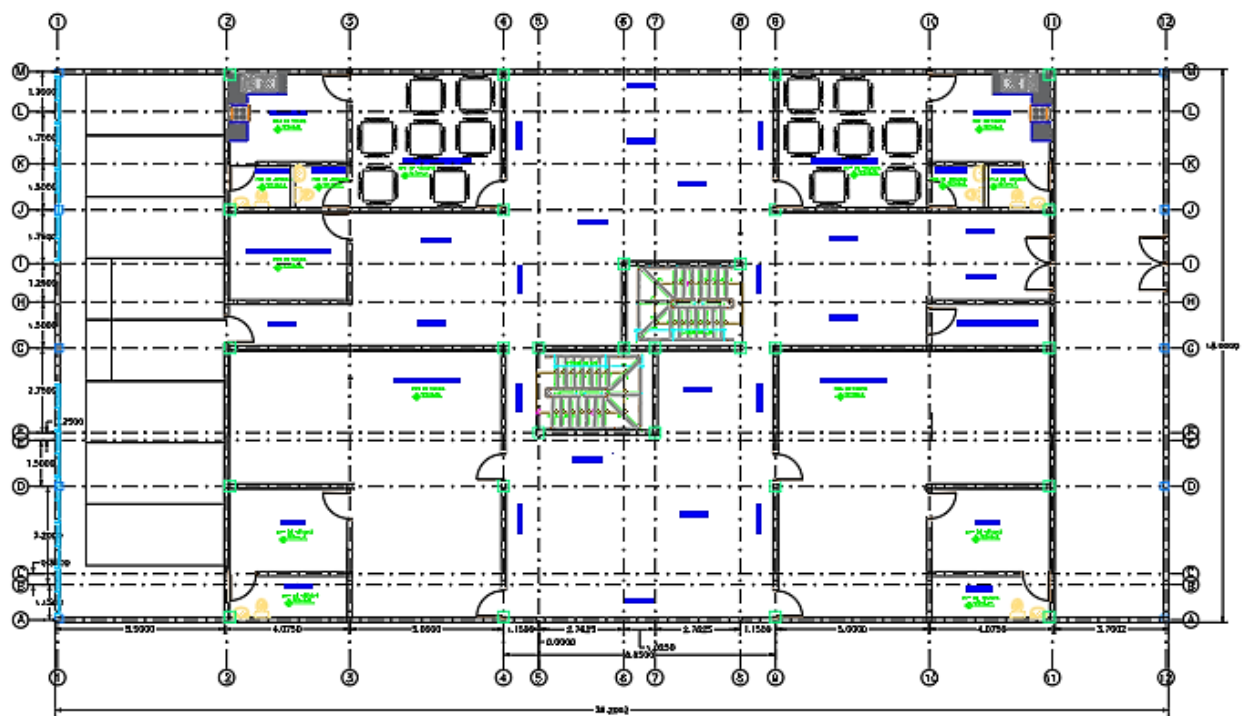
PLANO EN DETALLE DEL MODELO BASE ESTRUCTURAL.
